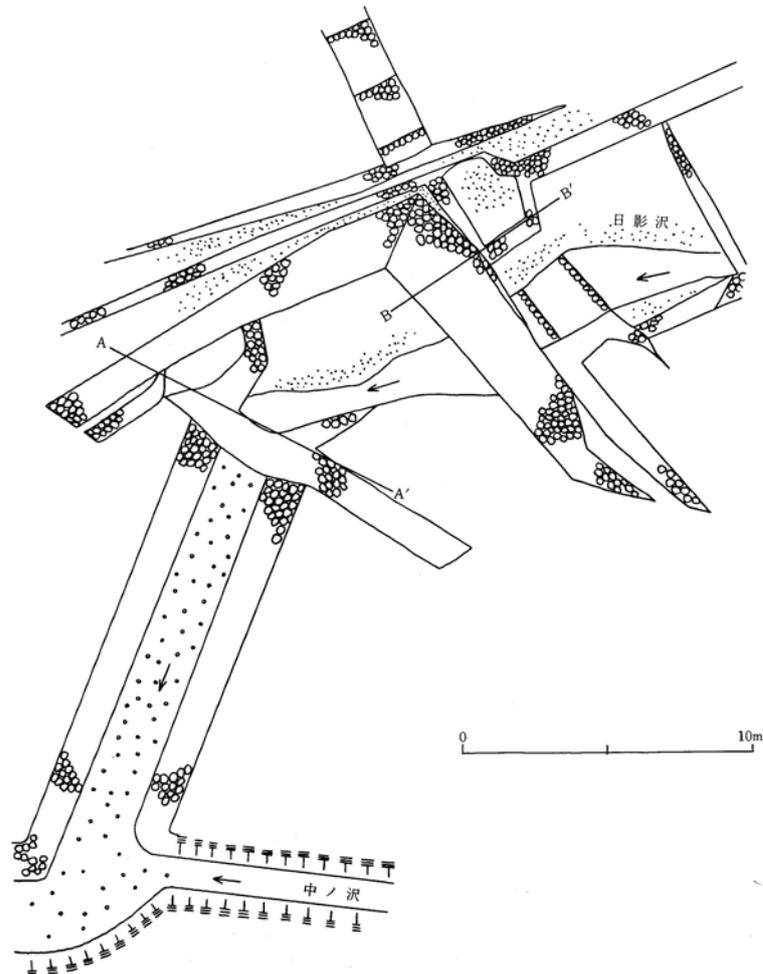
日影沢、中ノ沢合流点付近えん堤及張石水路平面図
